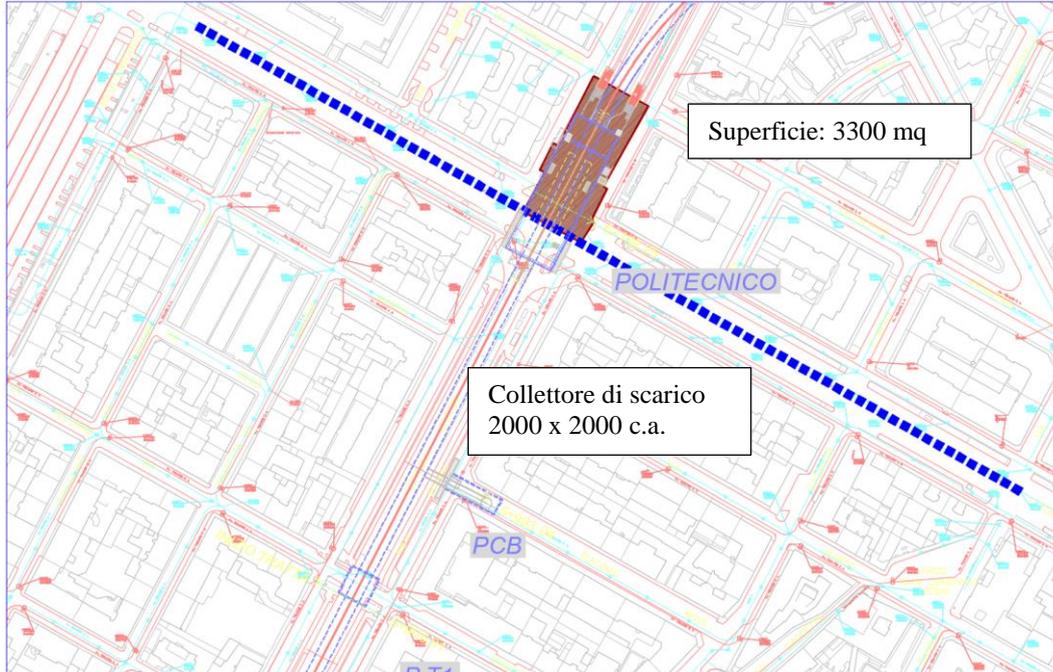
Aree di cantiere – Stazione Politecnico – FASE B
